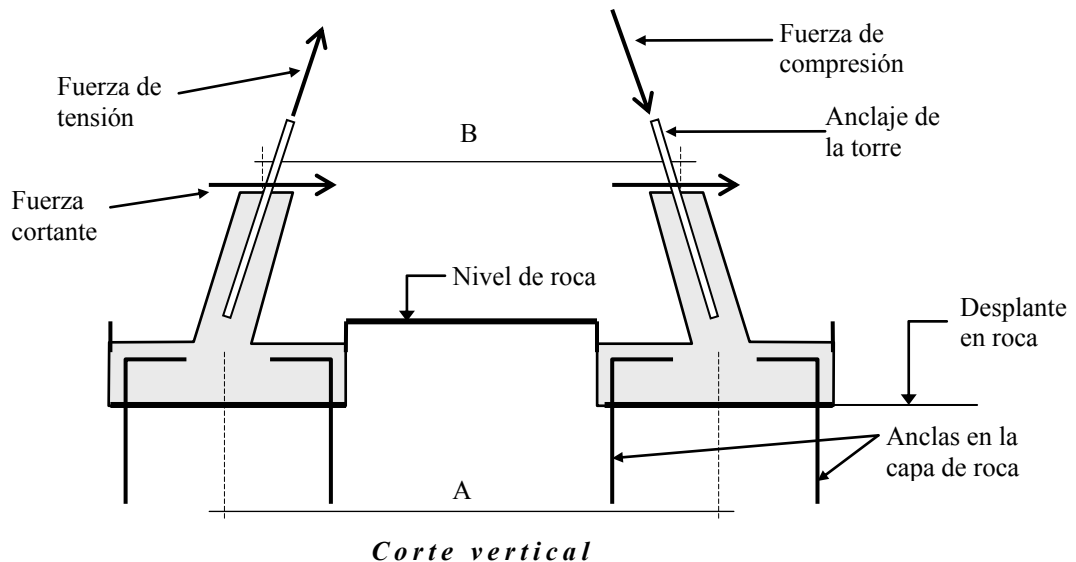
Fuerzas transmitidas a la cimentación con zapatas aisladas ancladas en roca
